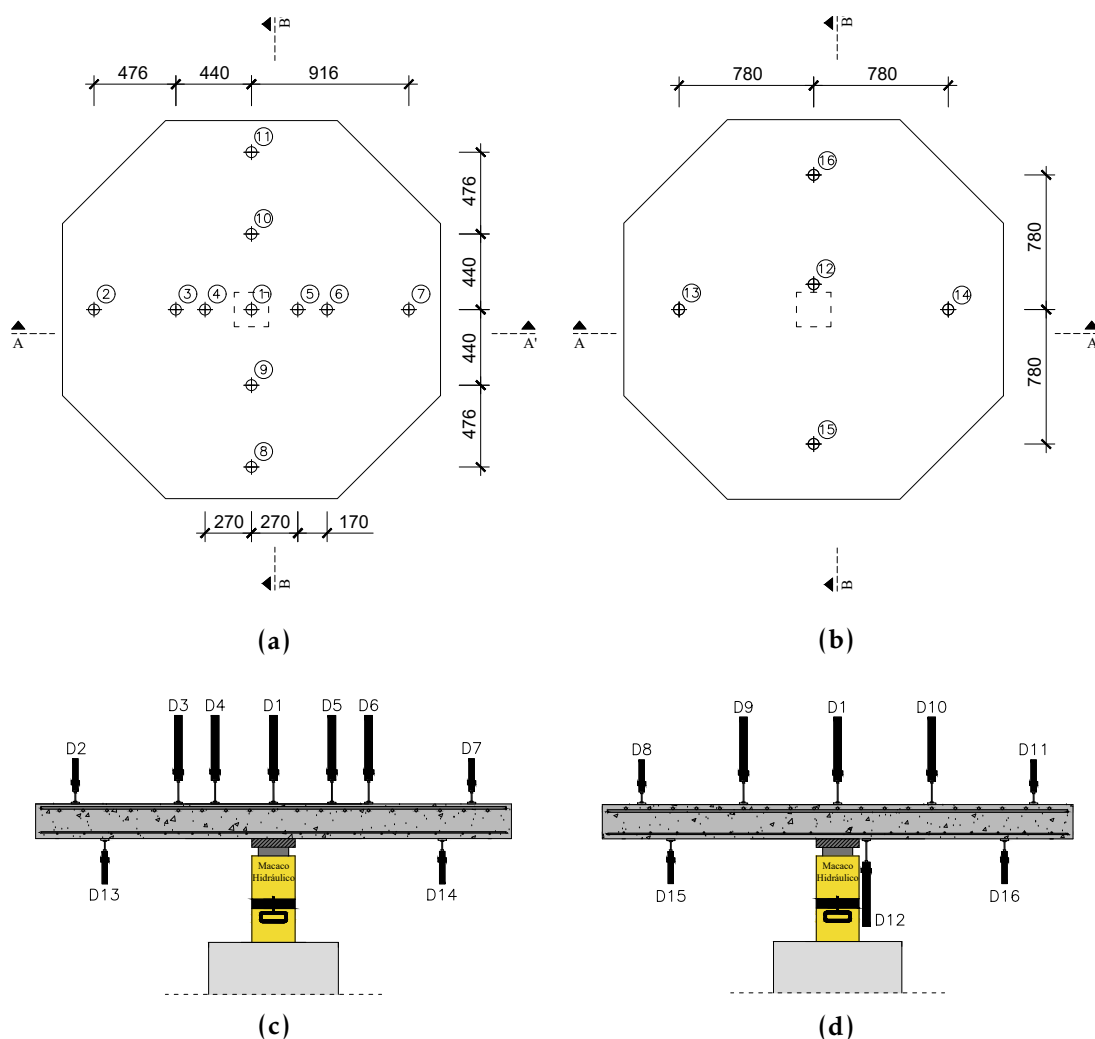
Localização dos deflectómetros na laje: (a) em planta na face superior, (b) em planta na face inferior, (c) corte A-A' e (d) corte B-B' (desenhos sem escala e dimensões em mm).
